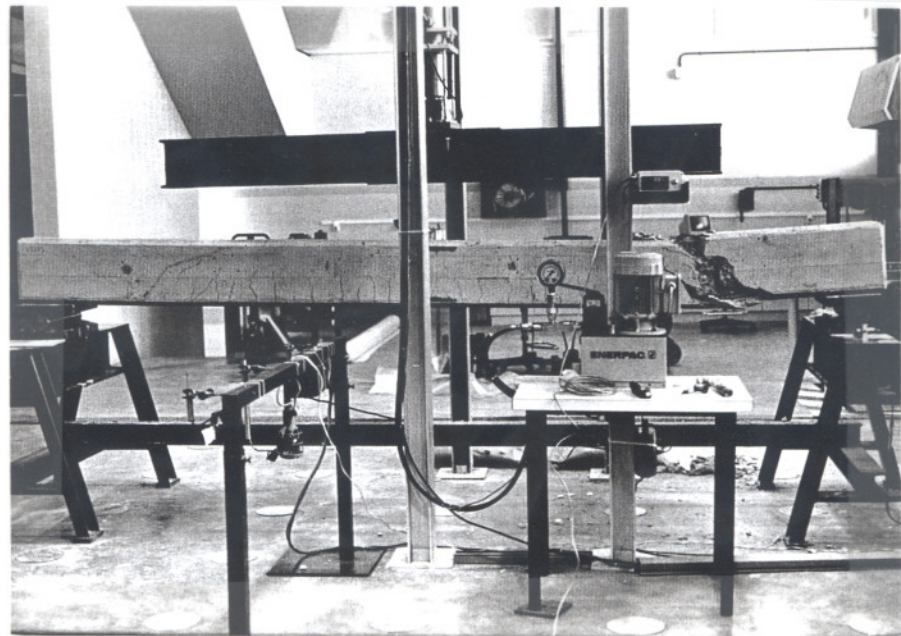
Las vigas de la segunda serie rompieron por cortante. Estado final de la viga R21.
